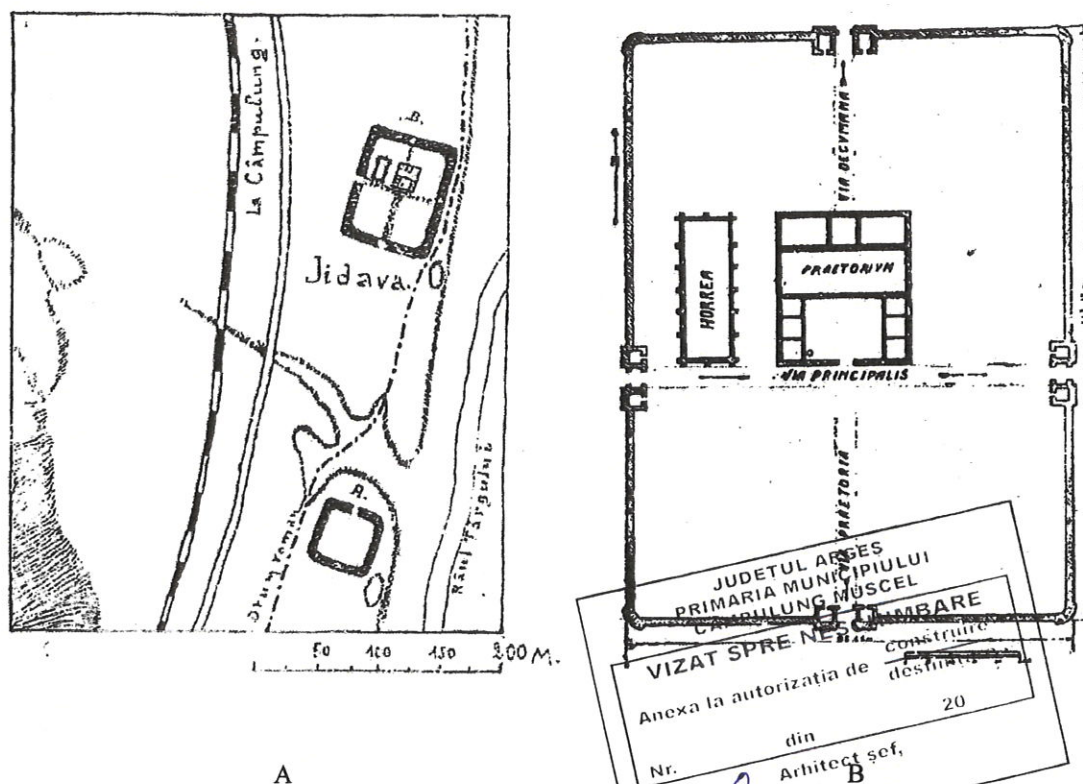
Schițe de plan alcătuite de Pamfil Polonic: a) amplasarea castrului; b) planul castrului cu zid de piatră (după TUDOR 1936).
